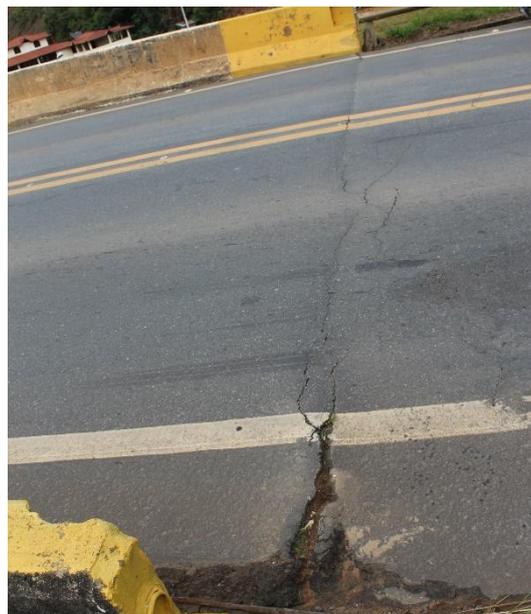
Fissuração devido à ausência de junta de dilatação.
